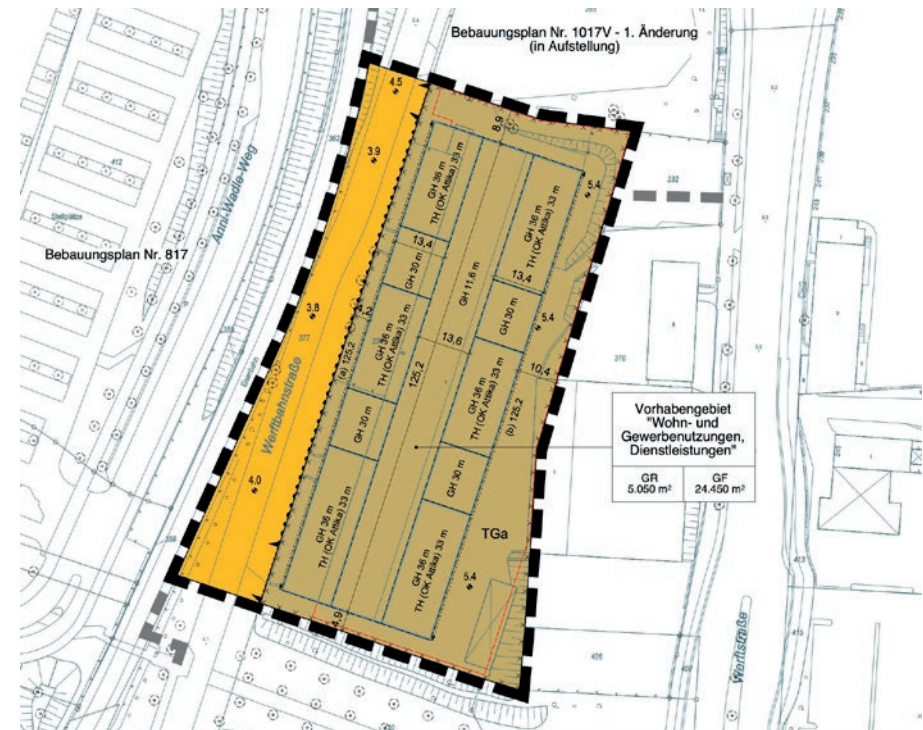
Auszug Planzeichnung Bebauungsplan-Entwurf Nr. 1031V (Landeshauptstadt Kiel, Stadtplanungsamt, Stand: 28.11.2022)
